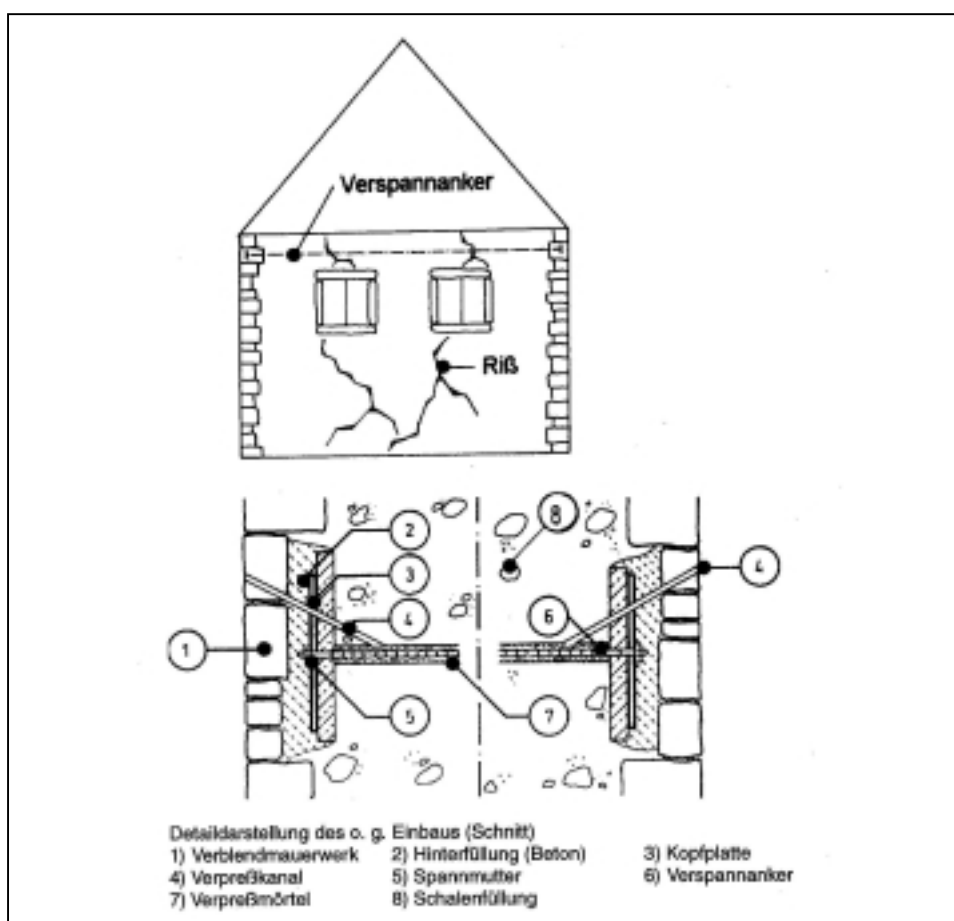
Prinzipdarstellung des Einbaus eines Spannankers mit allen erforderlichen Details (Verankerung über Endplatten) nach [34]
